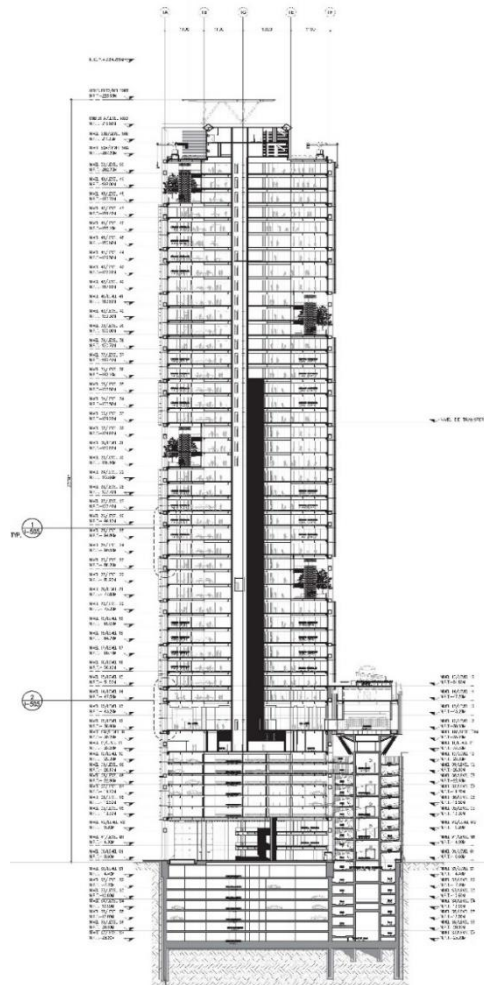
Corte transversal esquemático, tomado del set de planos de fit Out BBVA Bancomer, Copyright© 2014 Skimore, Owings & Merrill LLP.
